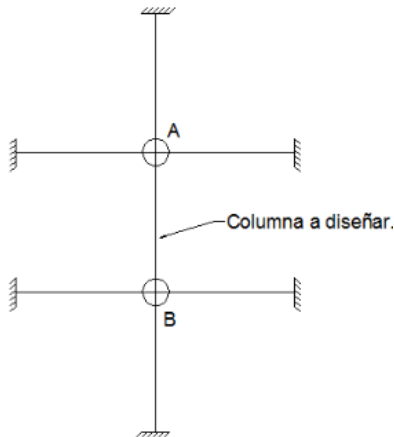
Posicionamiento de las vigas y columnas para el cálculo de "k". Fuente el autor.
